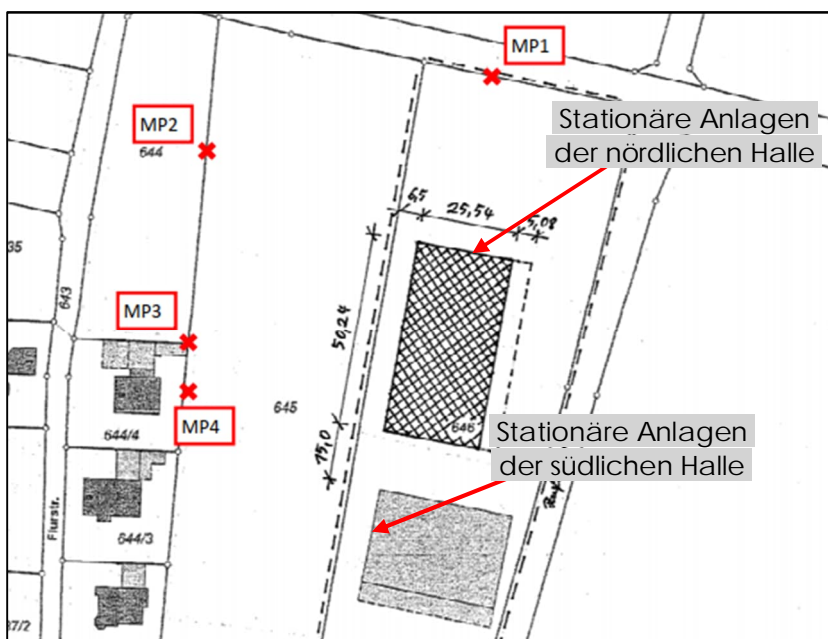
Lageplan mit Darstellung der Messpunkte der schalltechnischen Vermessung /11/
